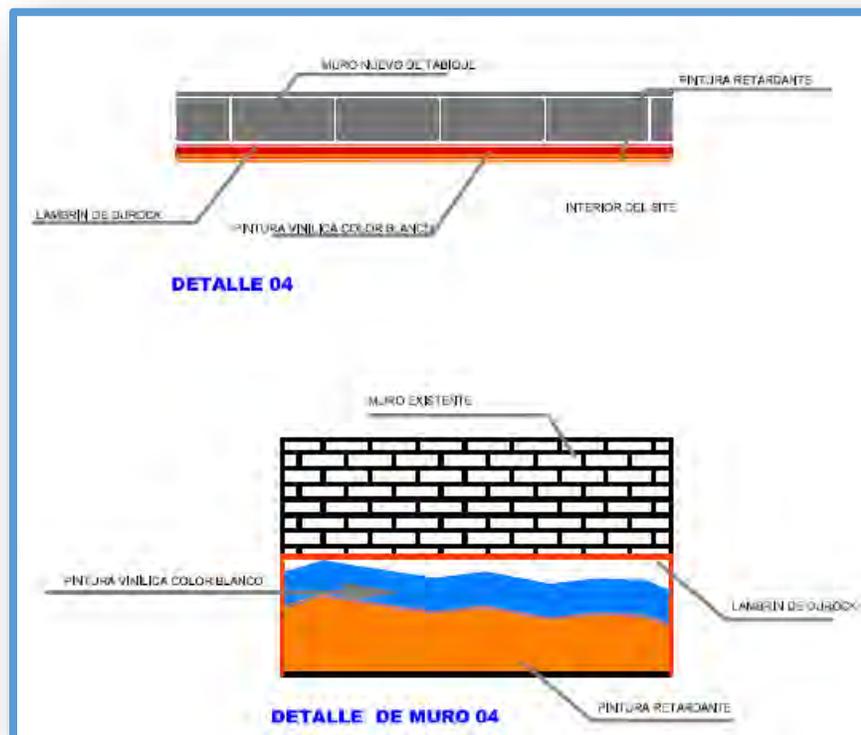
Detalle arquitectónico del muro 04 del Data Center.
